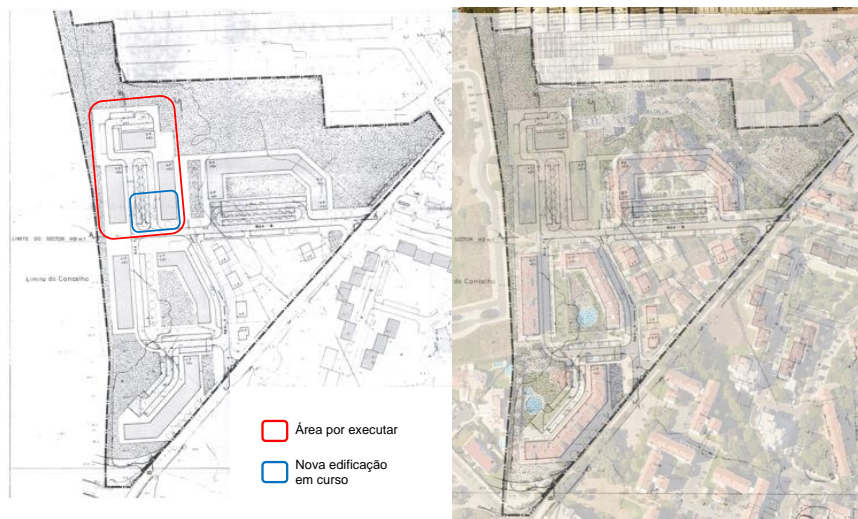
Área Envolvente, IGT: PPM – Planta de Implantação e sobreposição com imagem de satélite.
